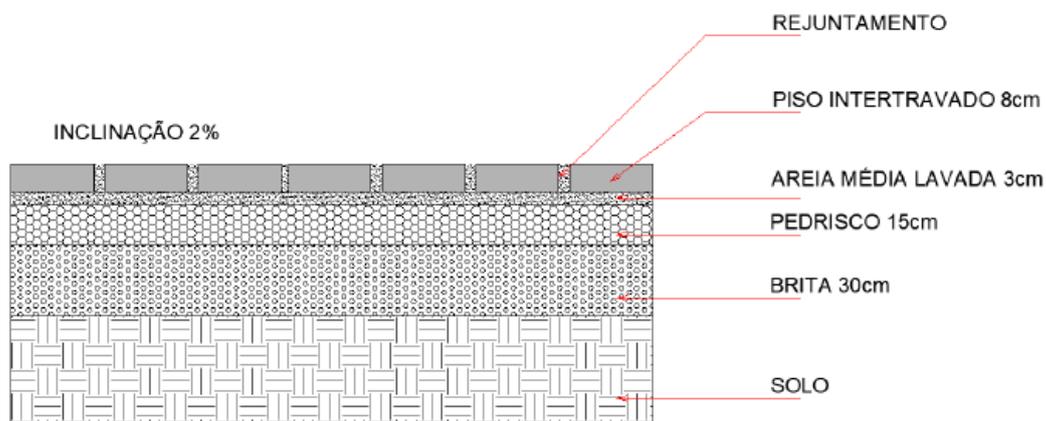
CORTE ESQUEMÁTICO PAVIMENTO INTERTRAVADO DE CONCRETO
